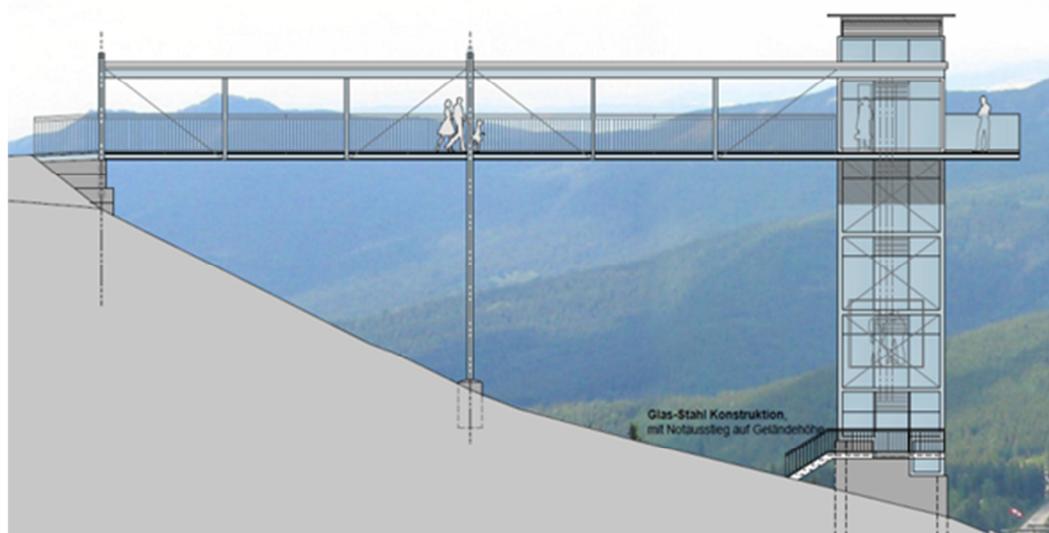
Plan eines Glasaufzug mit Brückenkonstruktion an der Arber Bergbahn
